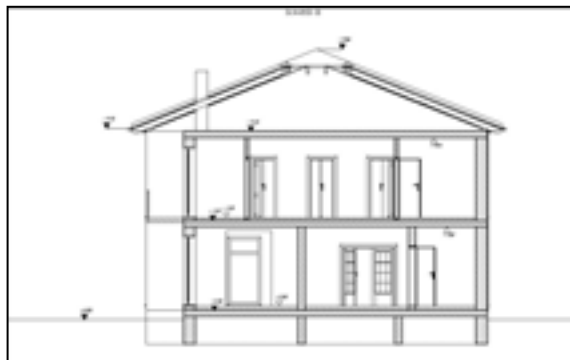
Schnitt eines geplanten Einfamilienhauses
